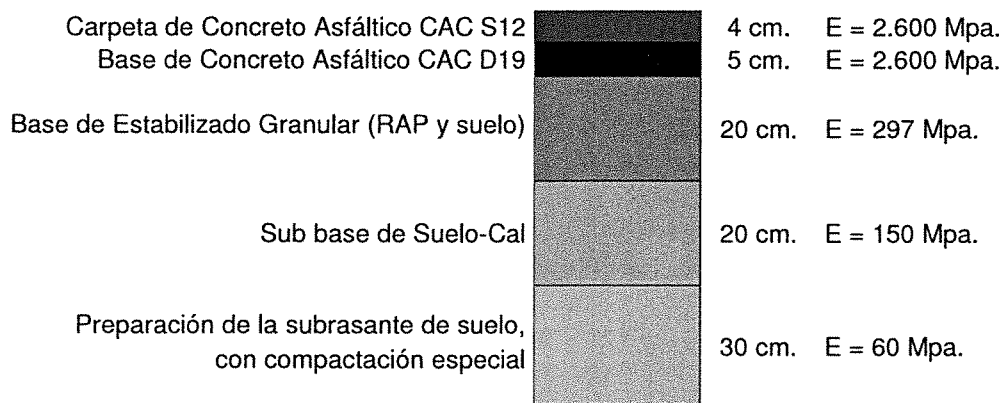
COLECTORA PAVIMENTADA - MODELO ESTRUCTURAL ADOPTADO
